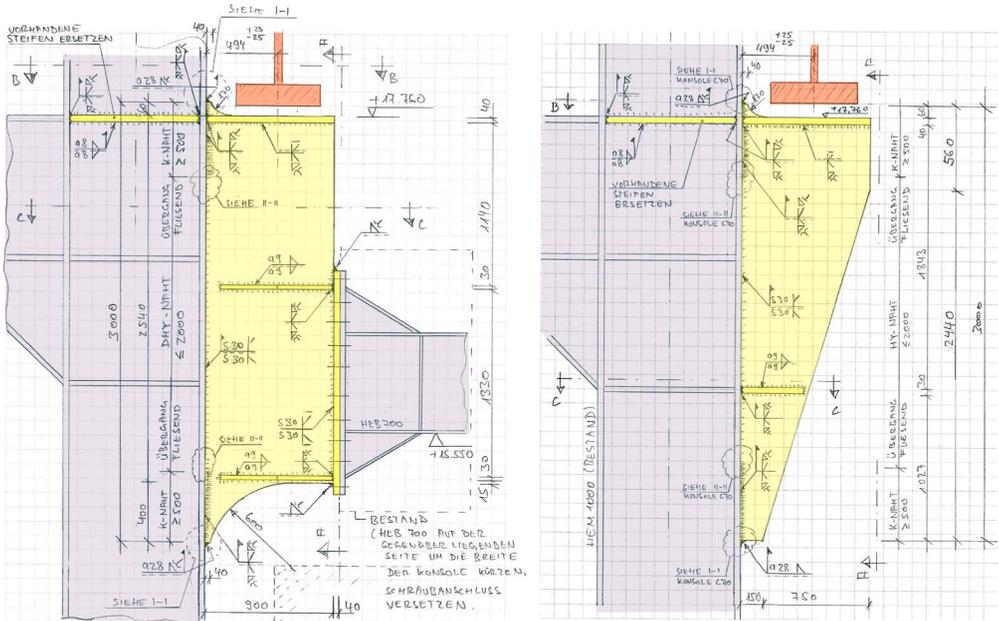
Geschweißte Varianten der Sonderkonsolen (links mit Kragarm)
